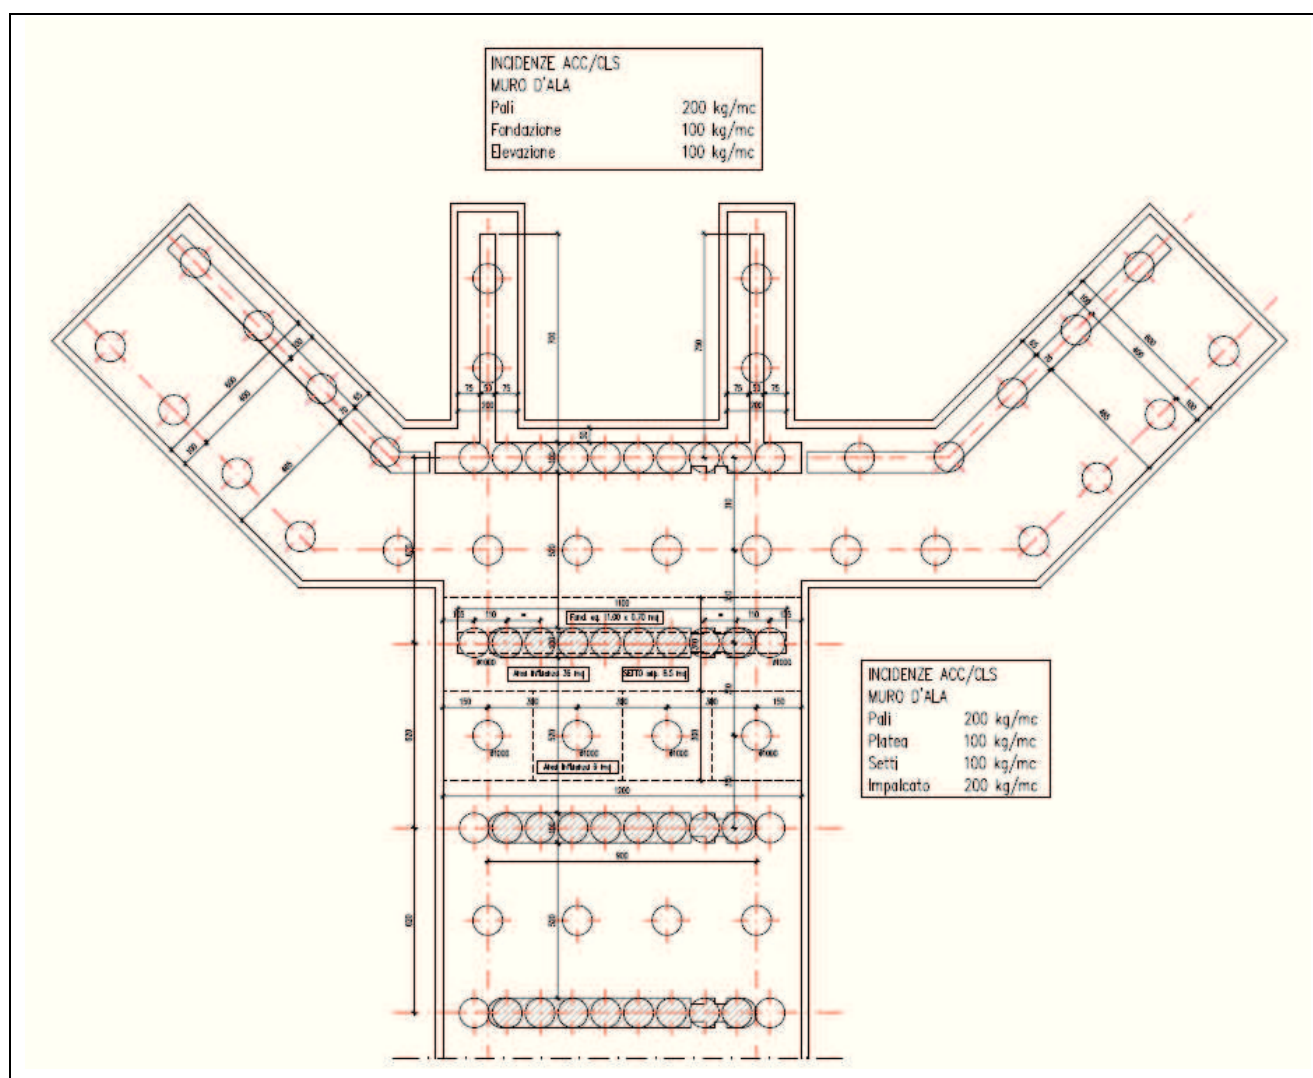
Stralcio planimetrico dell'Opera di Presa e del Muro d'Ala
